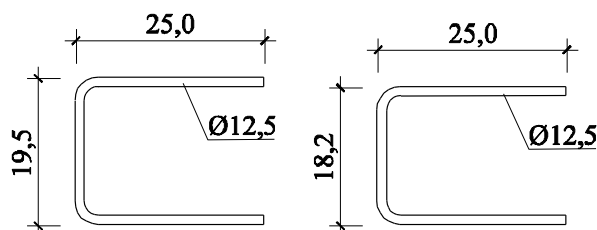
Armaduras de flexão das quatro lajes ensaiadas
